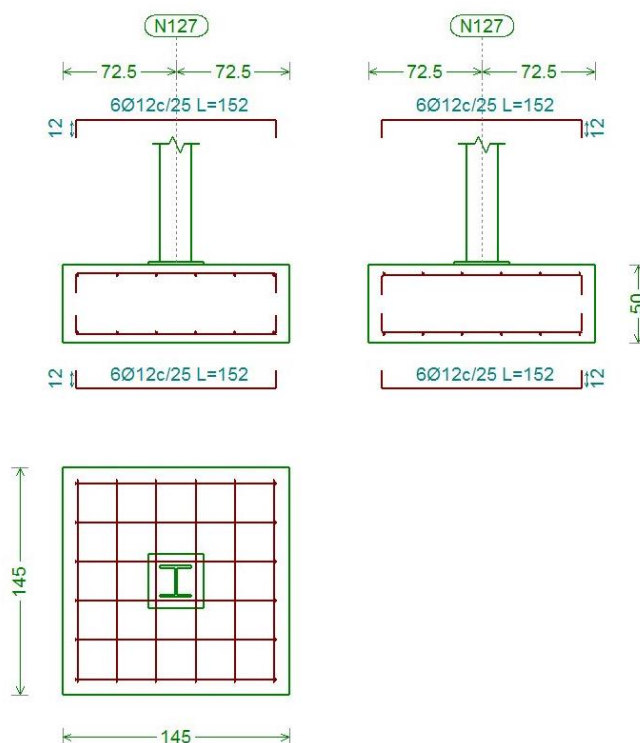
Dimensiones zapatas aislada oeste
